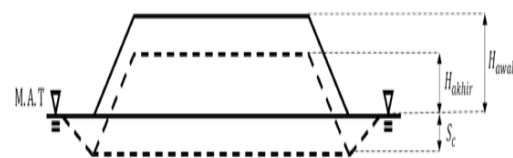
Cross Section Timbunan Jalan STA 414+525.
